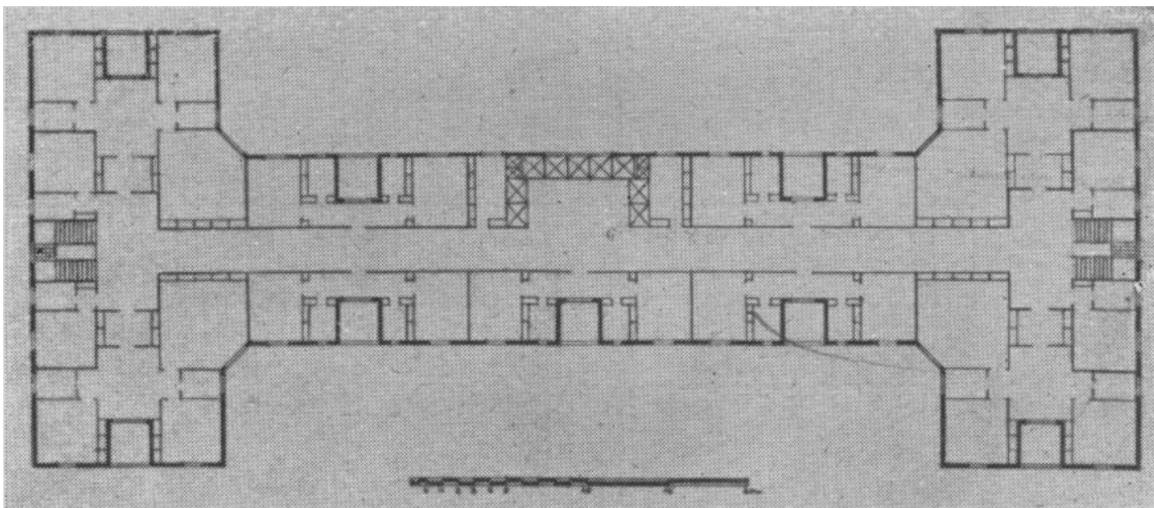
Ludwig Hilberseimer, Grundriss des Entwurfs für ein Boarding-House, 1923
